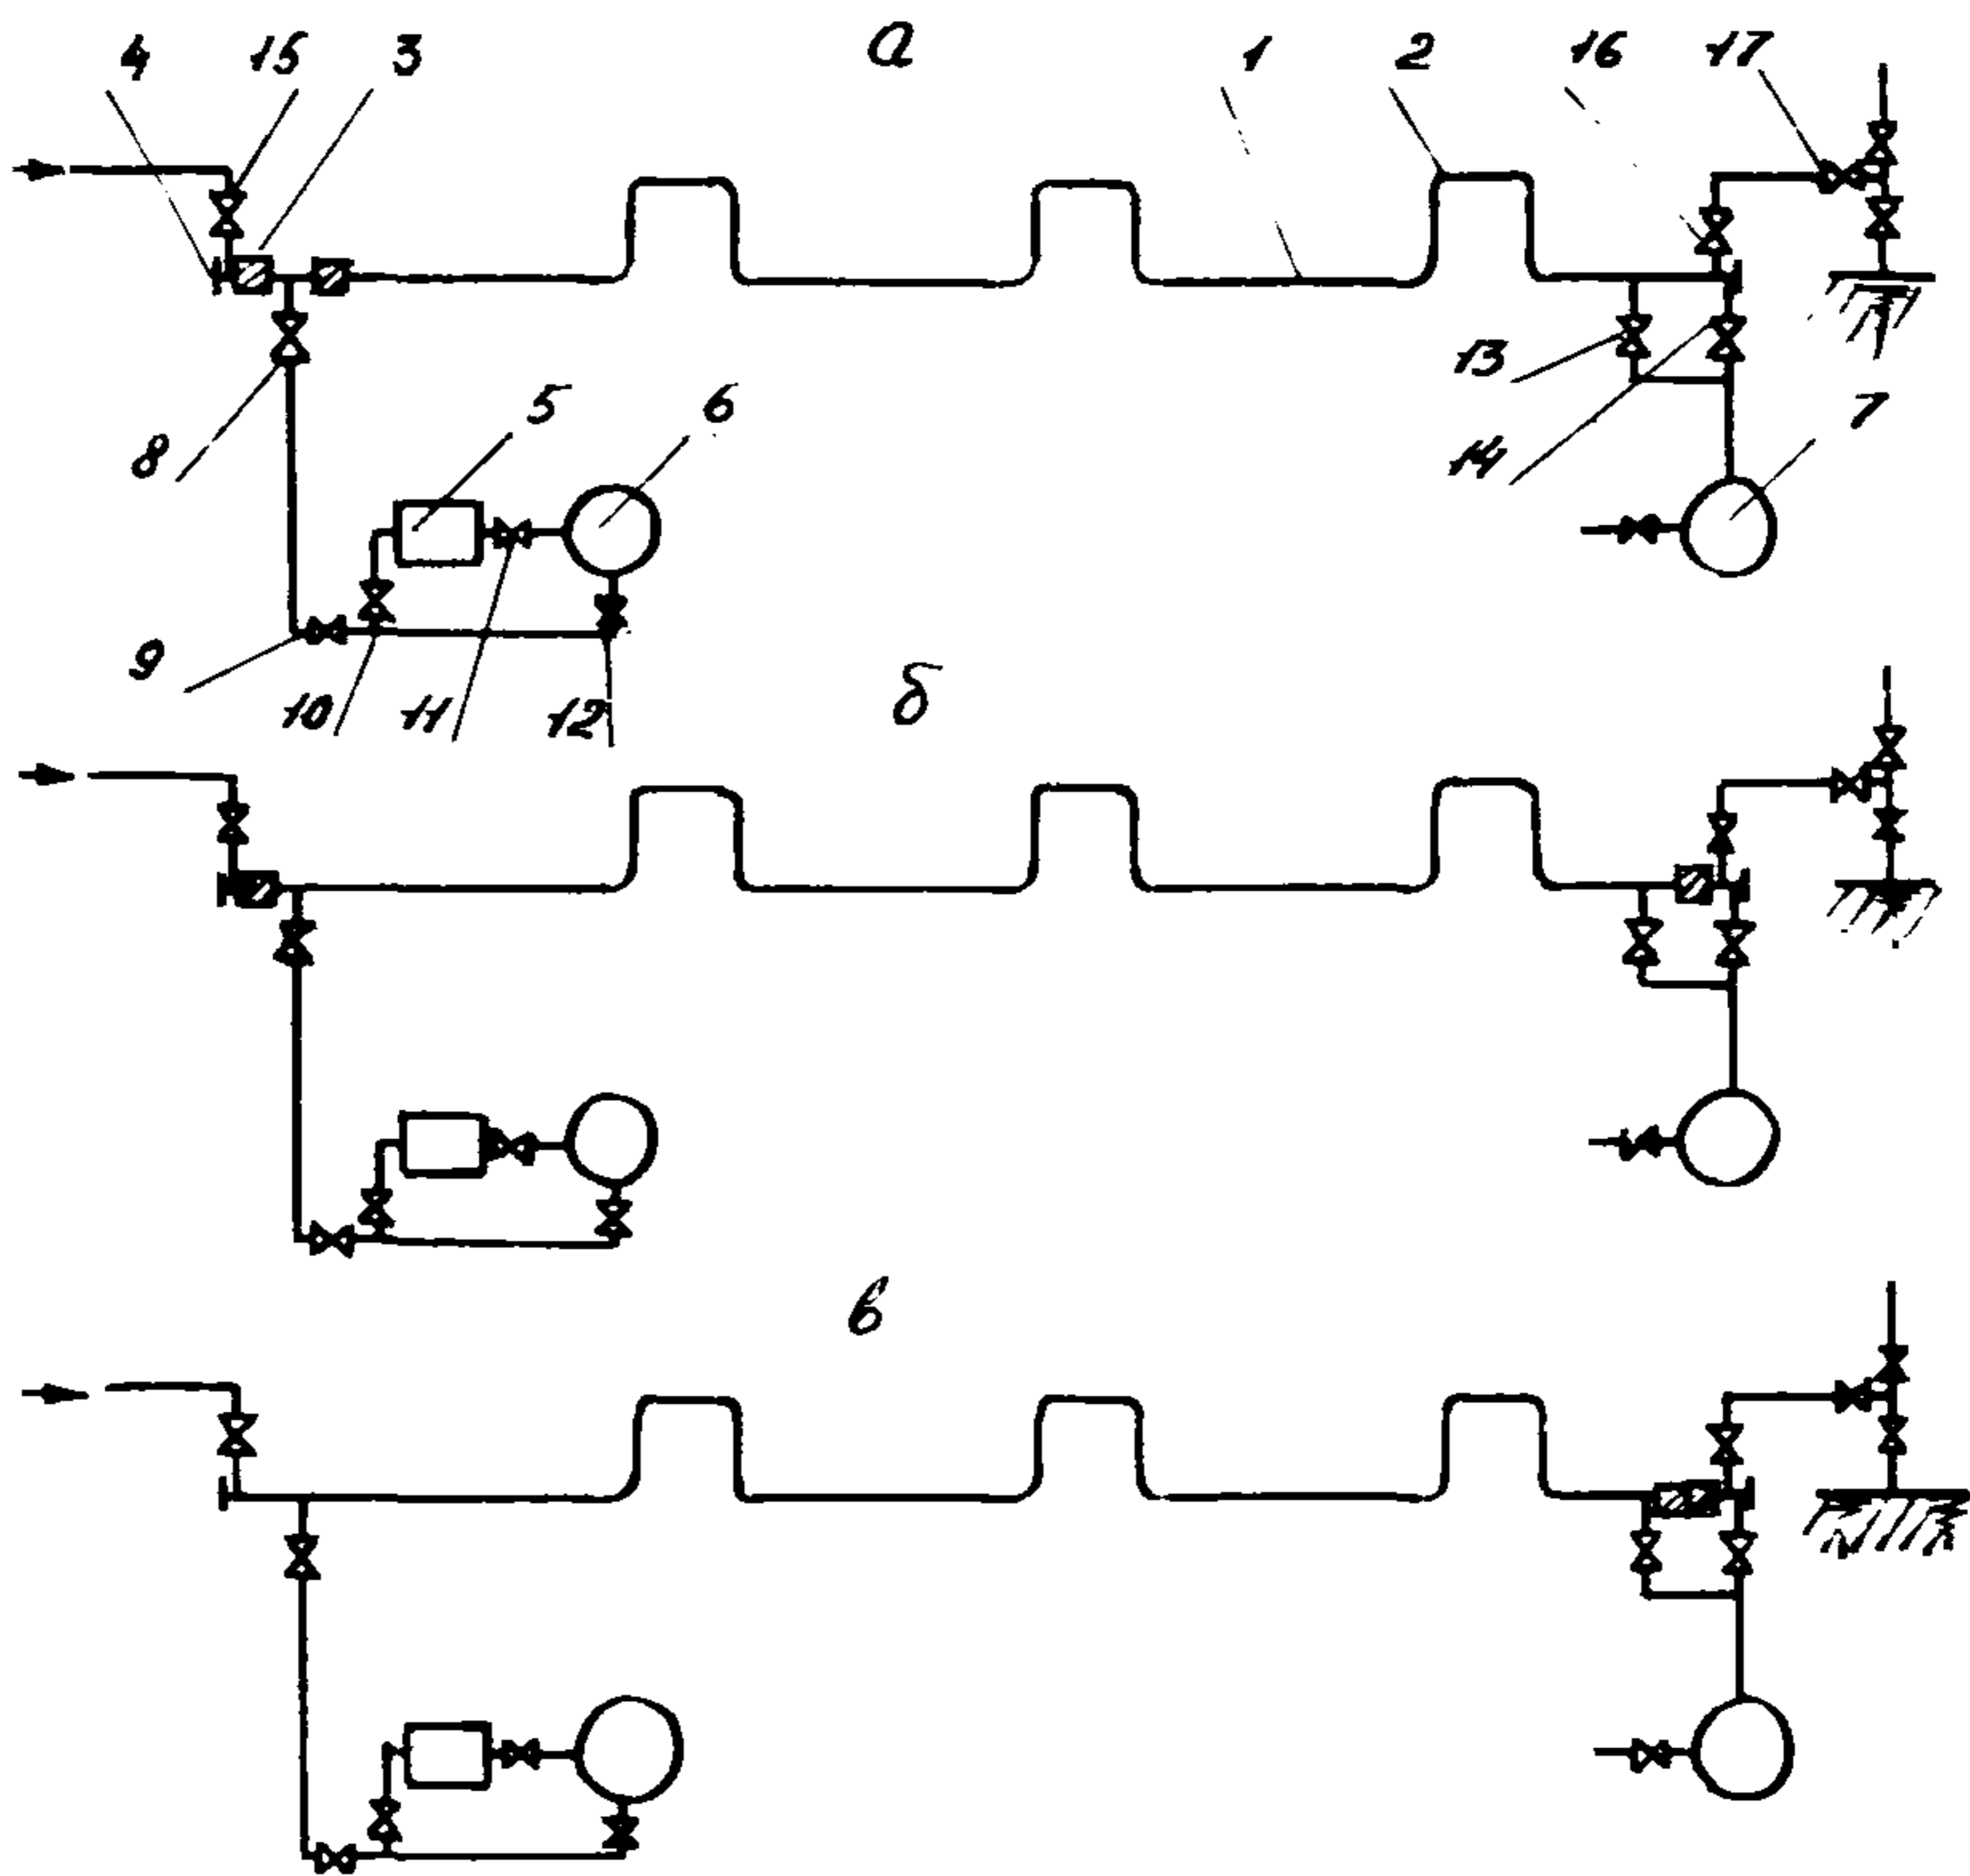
Схема испытания трубопровода жидкостью с пониженной температурой замерзания:
